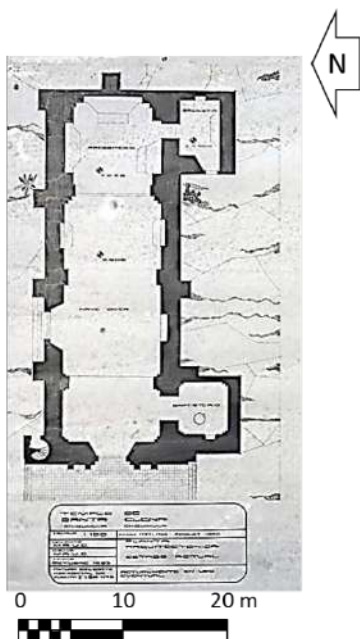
Planta arquitectónica del templo de Santa Elena. Fuente: Mario Ubico levantamiento década 1980
